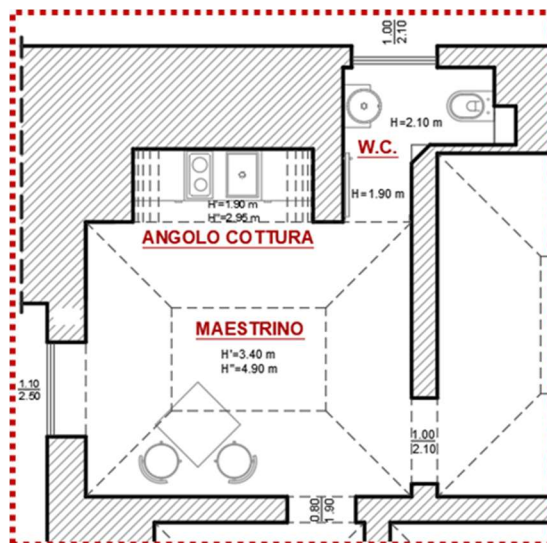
Stralcio planimetrico con differenziazione soluzione progettuale n. 1
